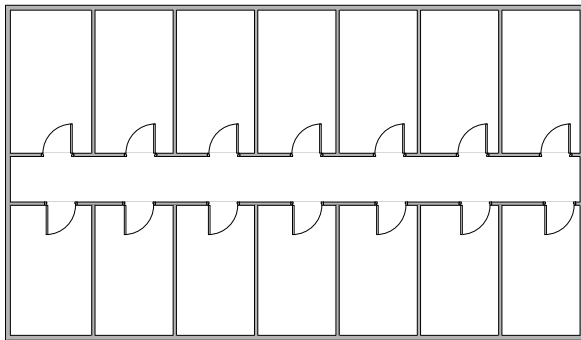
Darstellung Grundriss Wände
